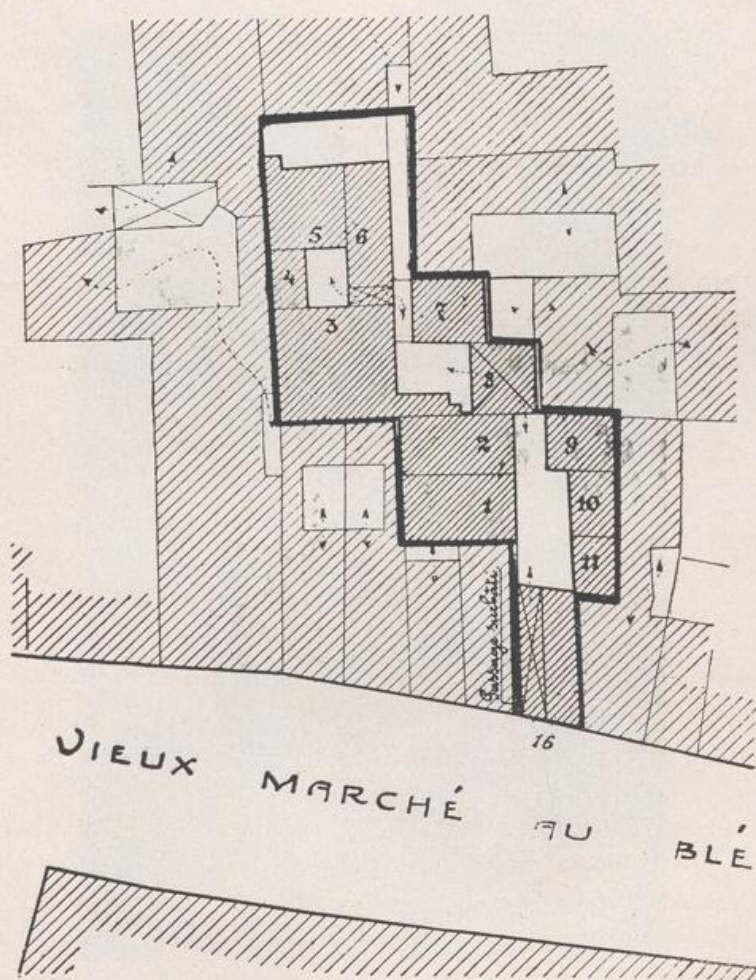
Vlaikengang, Grundriß. Maßstab 1 : 625.
